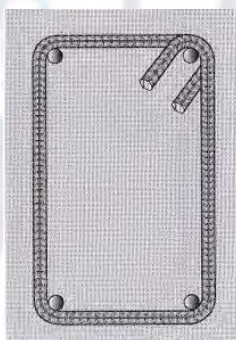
Estribos Corrugado tipo E para columnas y vigas
